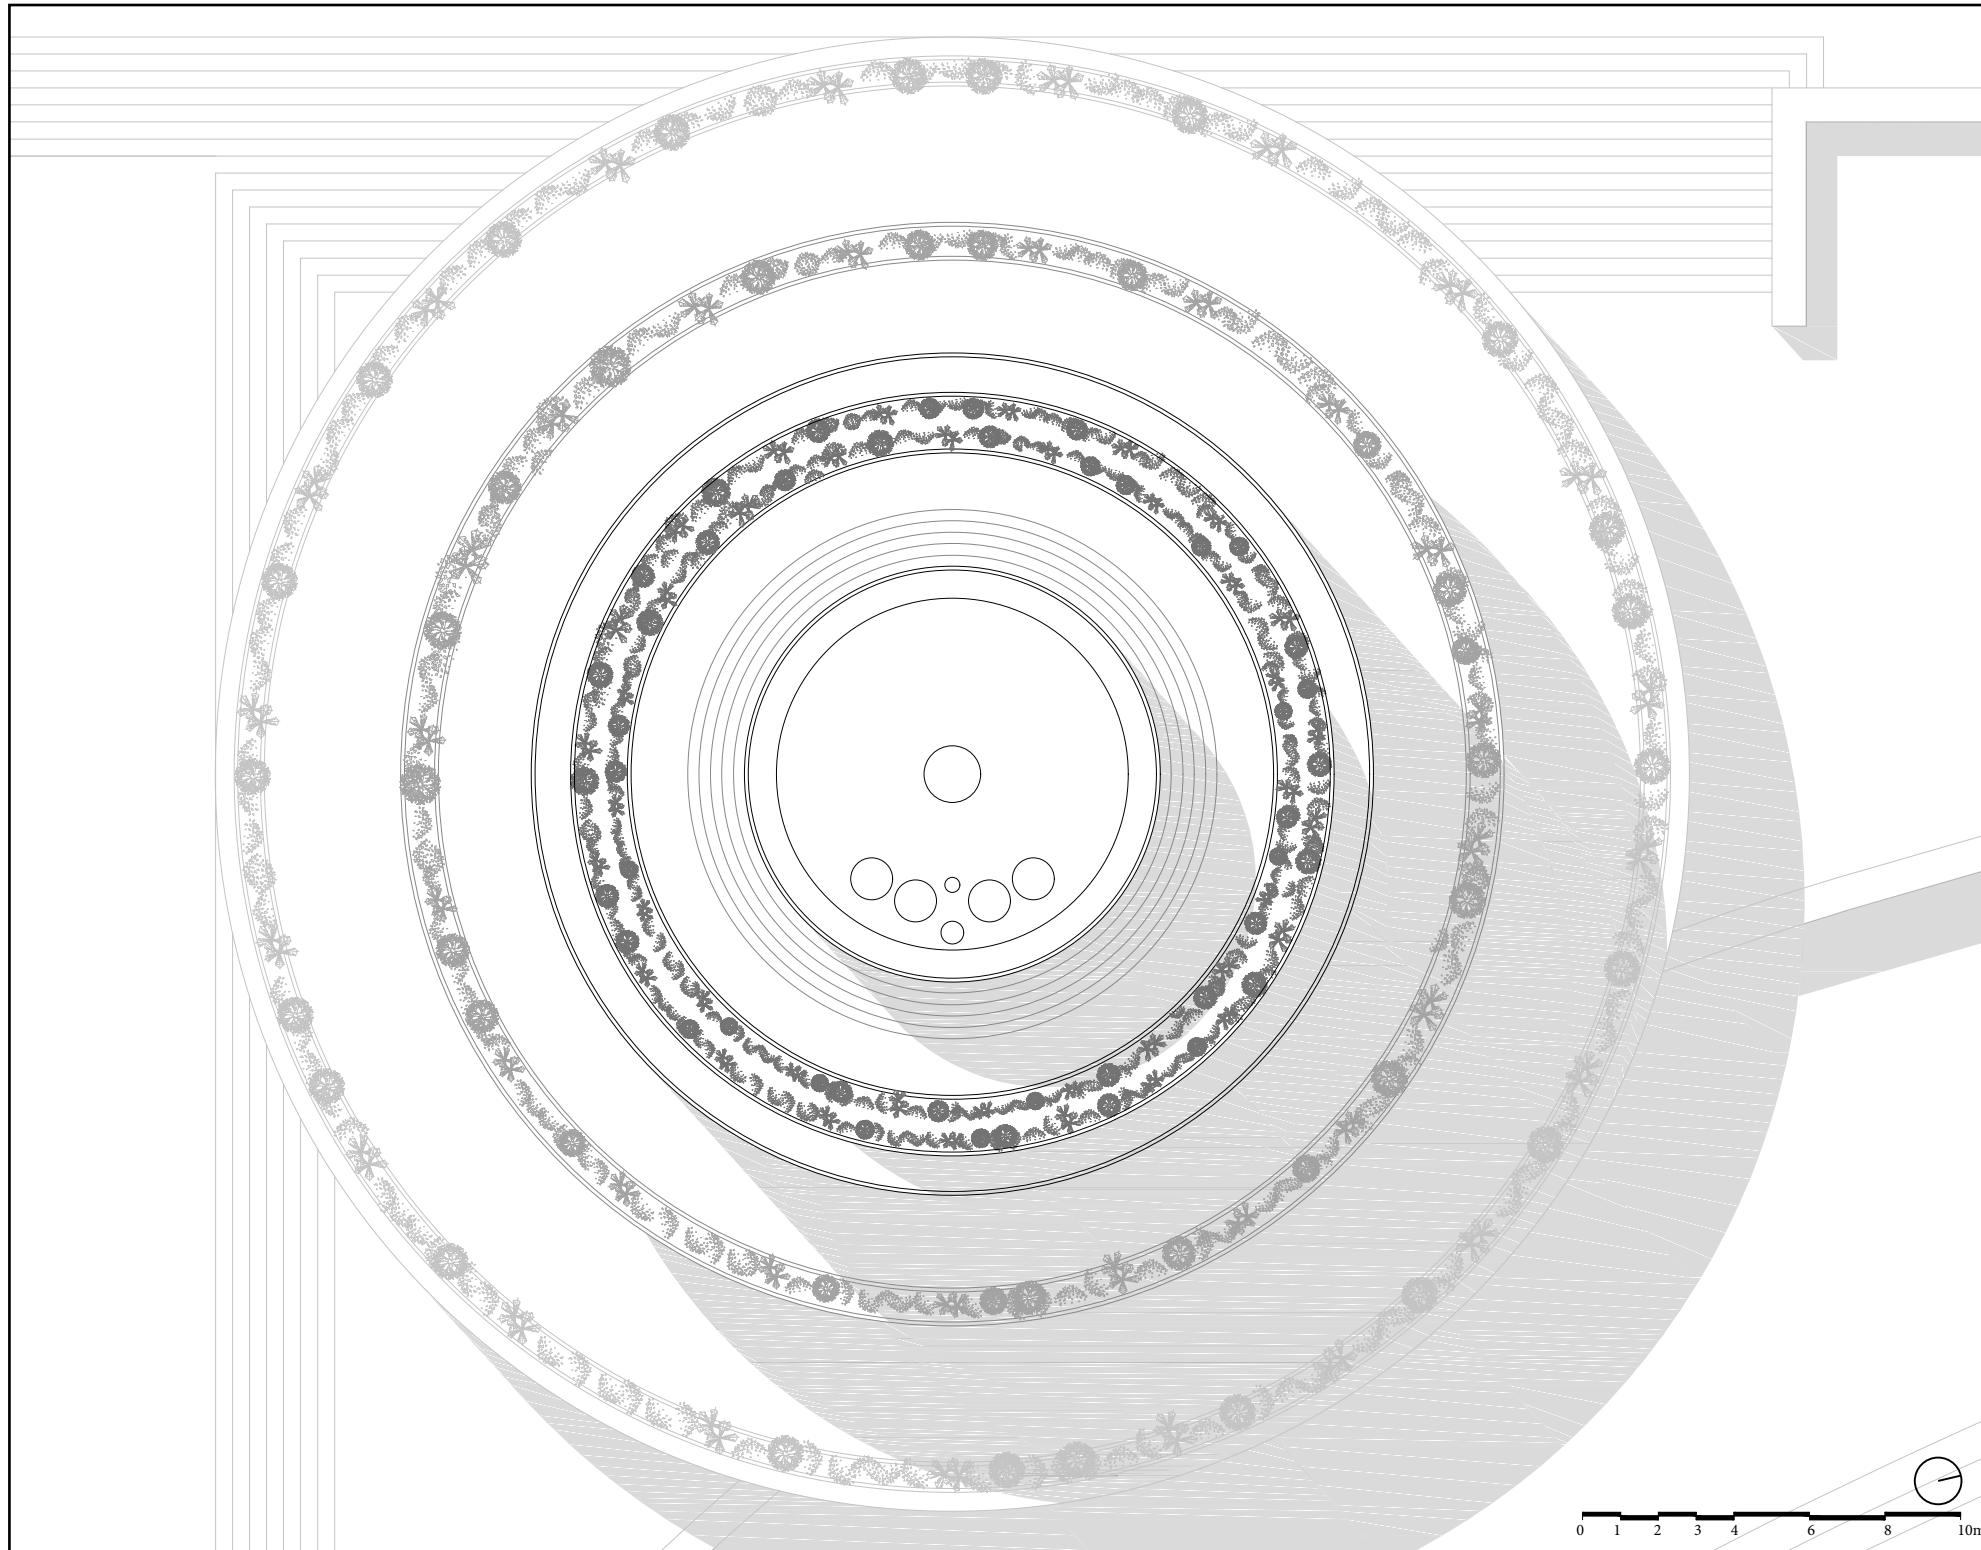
Planta Cubierta. [Fuente: Autor]
